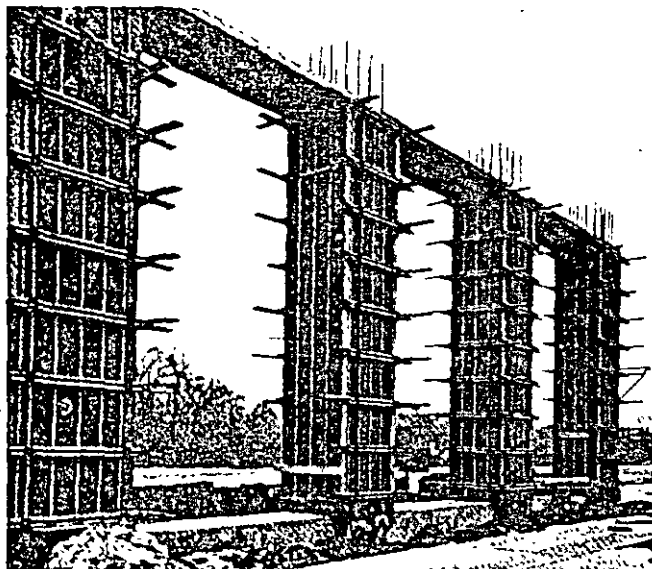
El aislamiento con cobertores o con bloques de materiales fibrosos puede aplicarse a la parte exterior de las cimbras construidas en obra o prefabricadas.
